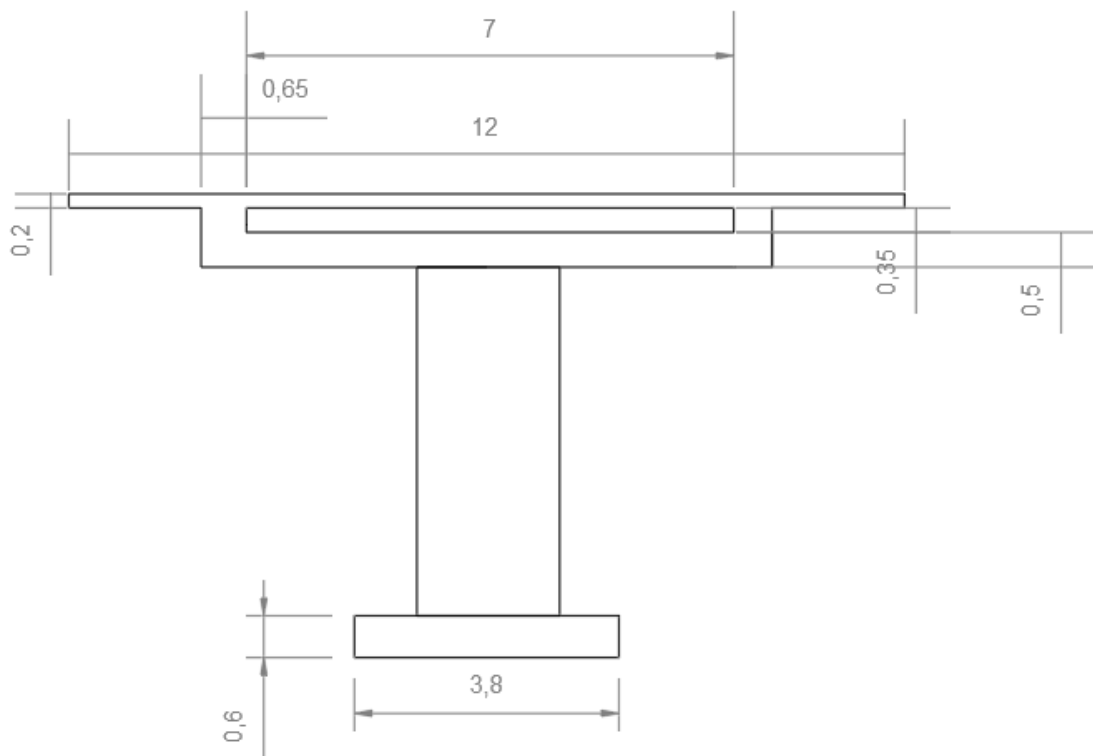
Sección transversal del puente con rigidez a torsión predominante en tablero, Modelo Nuevo
